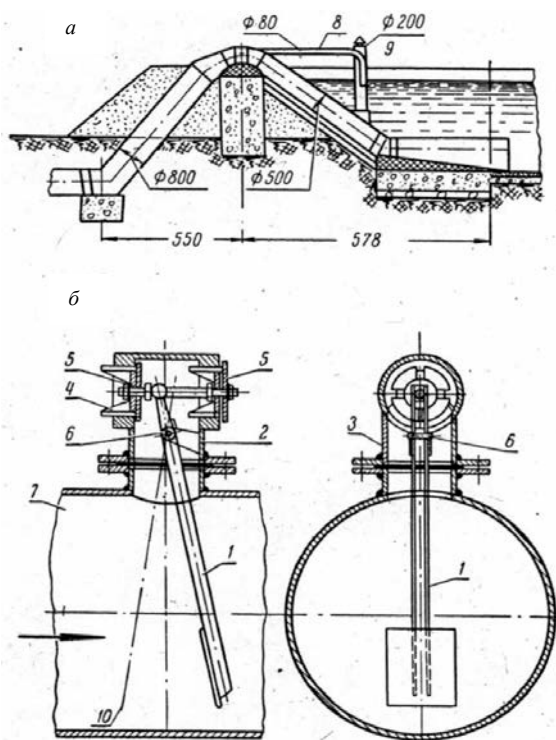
Устройства для срыва вакуума в сифоне: *а* – гидравлический клапан; *б* – клапан; 1 – рычаг с лопаткой; 2 – корпус; 3 – горловина; 4 – сухарь; 5 – клапаны; 6 – ось вращения рычага с лопаткой; 7 – напорный трубопровод; 8 – трубка; 9 – металлический стакан; 10 – положение лопатки при обратном токе воды
